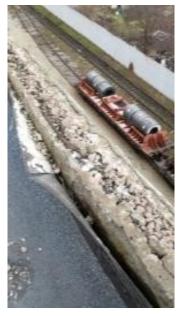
Отсутствует фартук по парапету, отклеивание рулонного гидроизоляционного ковра, разрушение парапета
